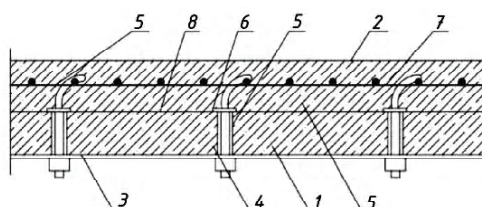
Устройство железобетонного нарастивания сверху плиты при недостаточном сцеплении нового бетона со старым: 1 – усиваемая железобетонная плита; 2 – железобетонное нарастивание; 3 – стальная полоса, прикрепленная к плите анкерными стержнями; 4 – анкерные стержни с крюками, установленные в просверленные отверстия; 5 – отверстия, просверленные в плите; 6 – шайбы; 7 – арматурная сетка, прикрепленная к плите анкерными стержнями; 8 – поверхность усиваемой плиты, подготовленная к бетонированию.
